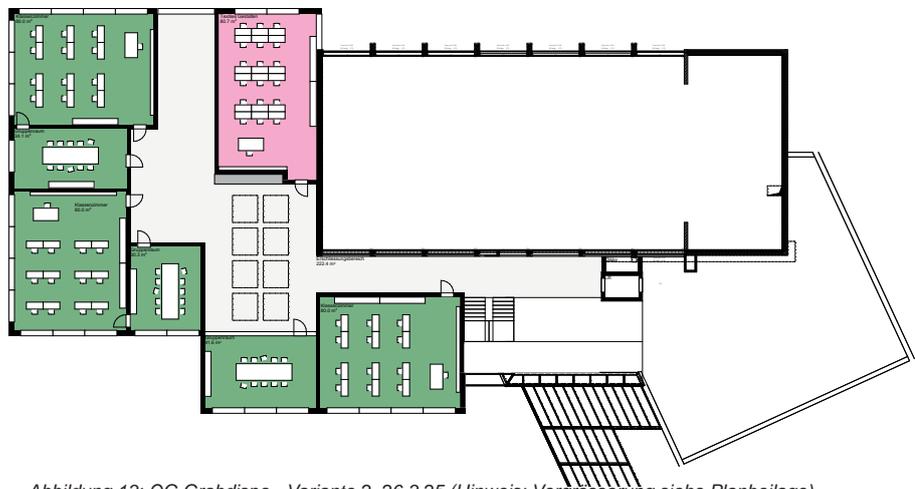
OG Grobdispo - Variante 2, 26.3.25 (Hinweis: Vergrößerung siehe Planbeilage)
